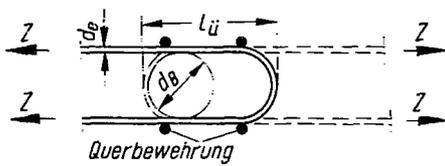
Übergreifungsstoß mit Schlaufen (Draufsicht)
